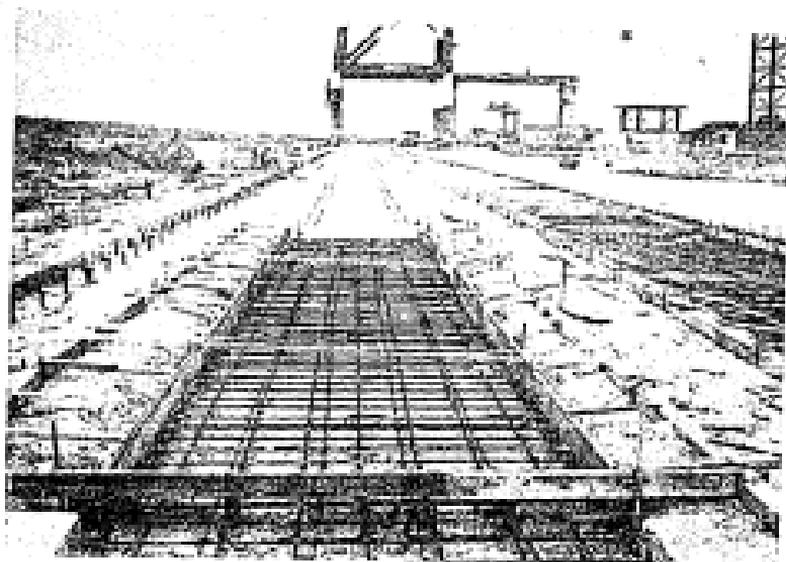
CONSTRUCCIÓN DE LOSA PARA VIAS DE FERROCARRIL.
